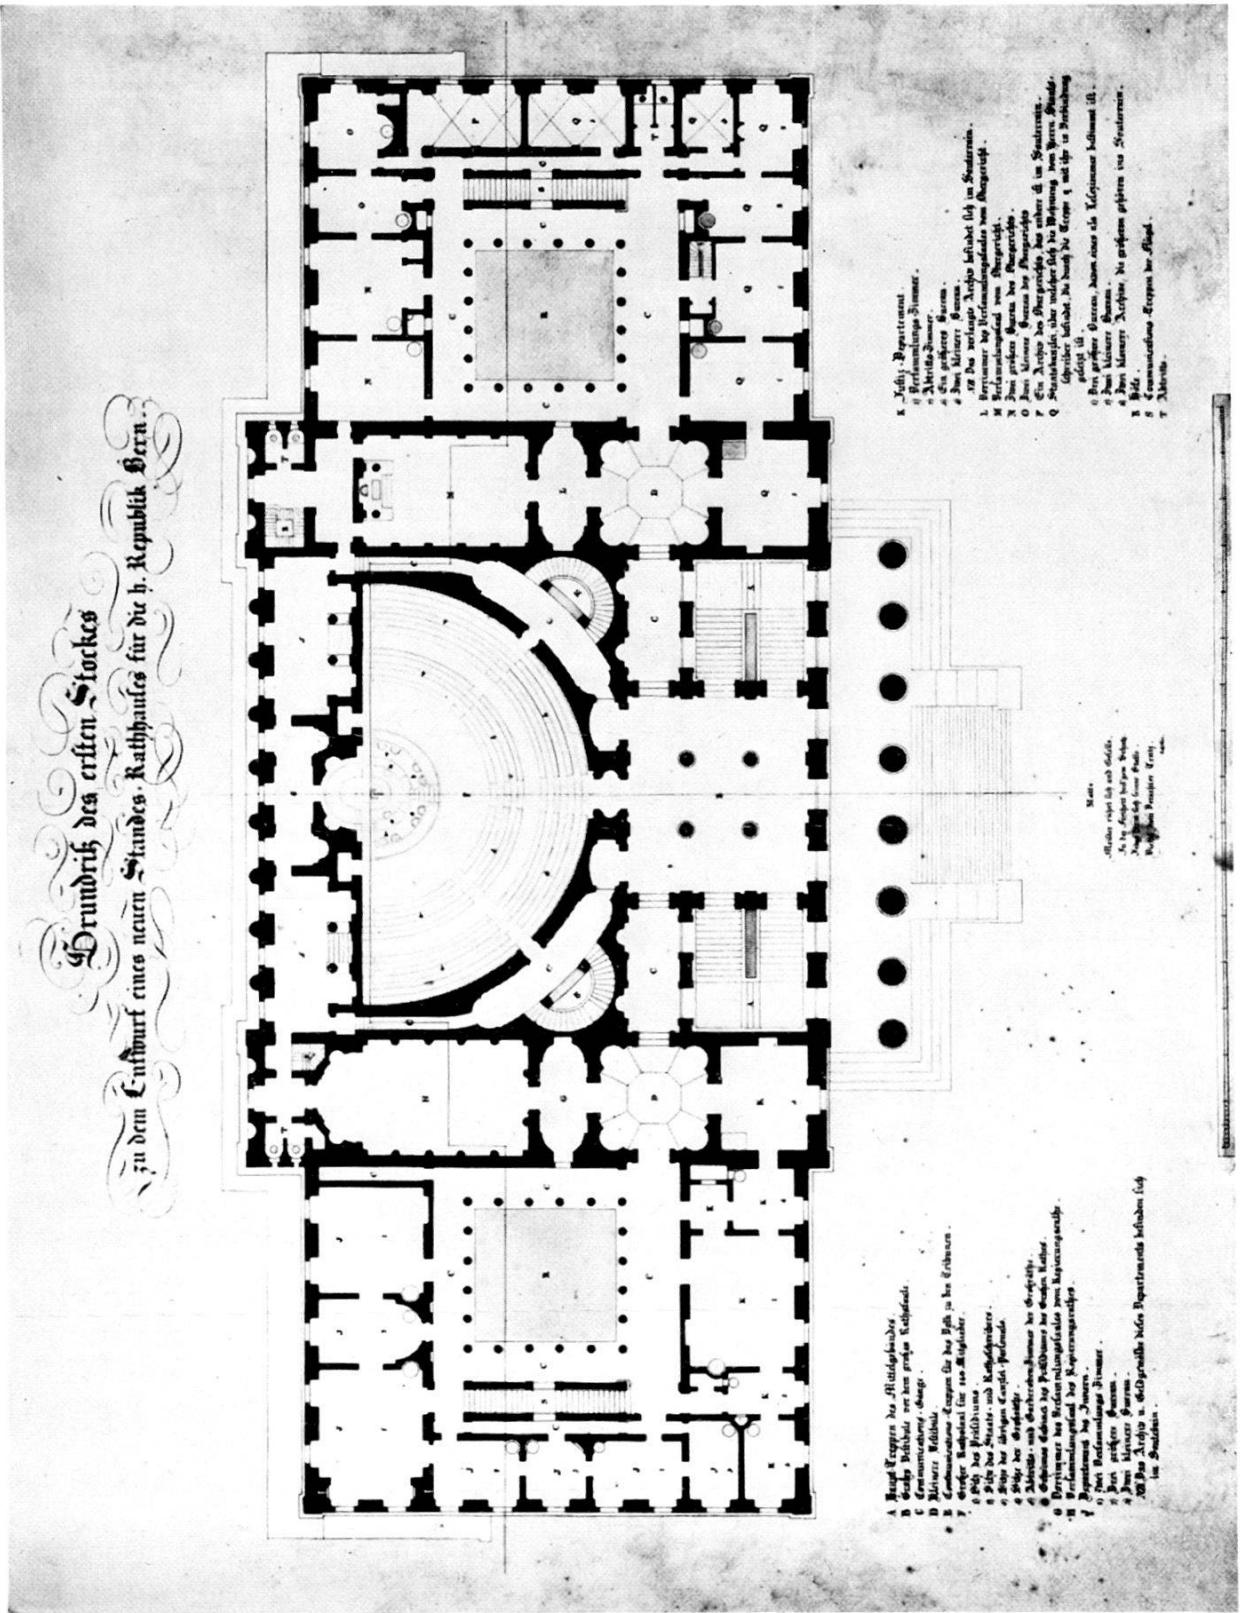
Berri, Rathaus Bern, Grundriss Hauptgescchoß. – Photo Denz-Cliche, Bern.
